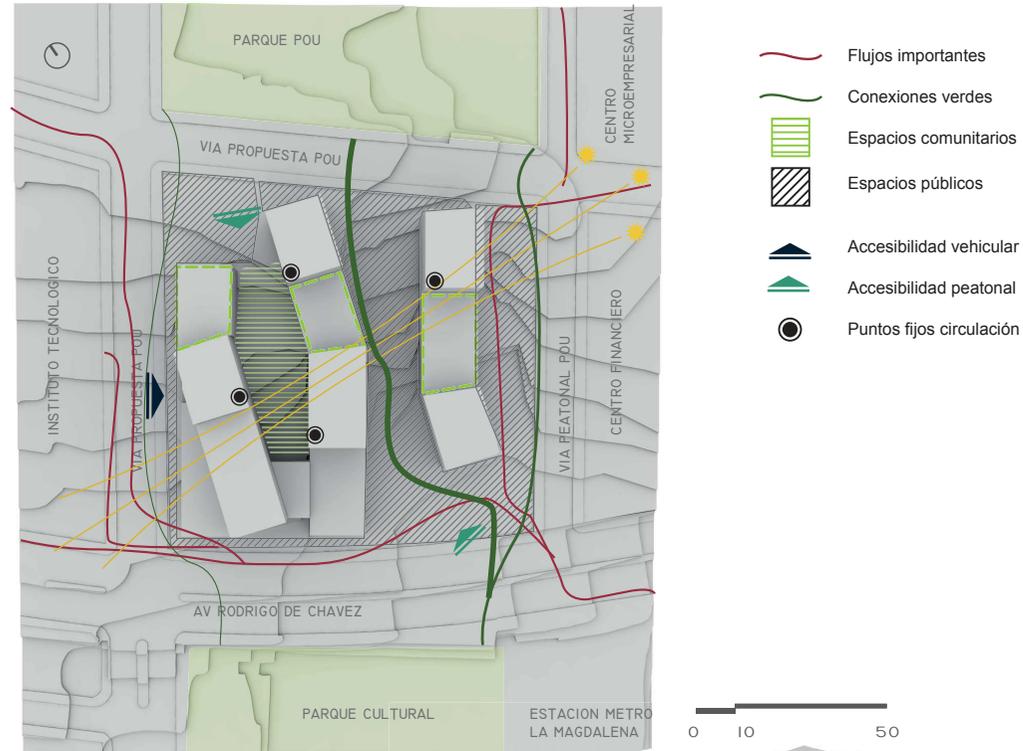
Propuesta 4 plan masa - implantación y estrategias
